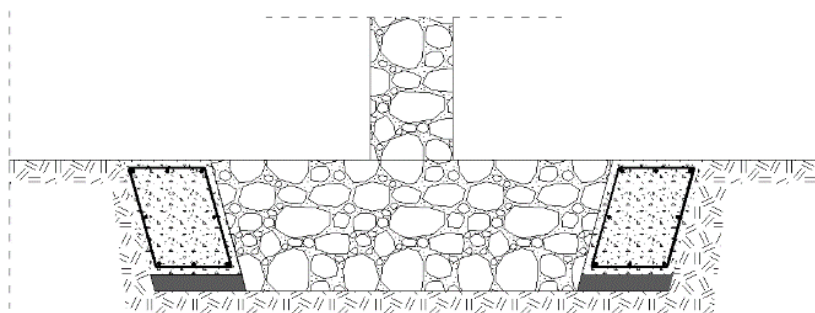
Refuerzo zapata. 2015. Rehabilitar con acero.
